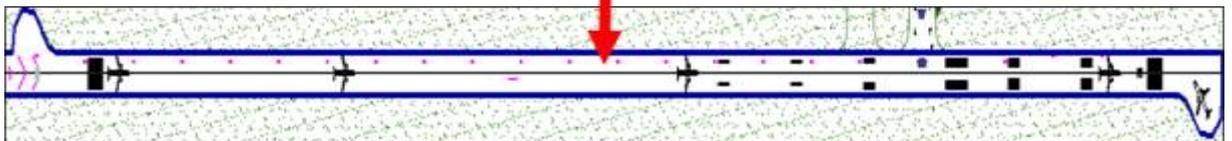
Pista de Aterrizaje; Fuente: Plano Zonificación Módulos 1° Nivel A-01
